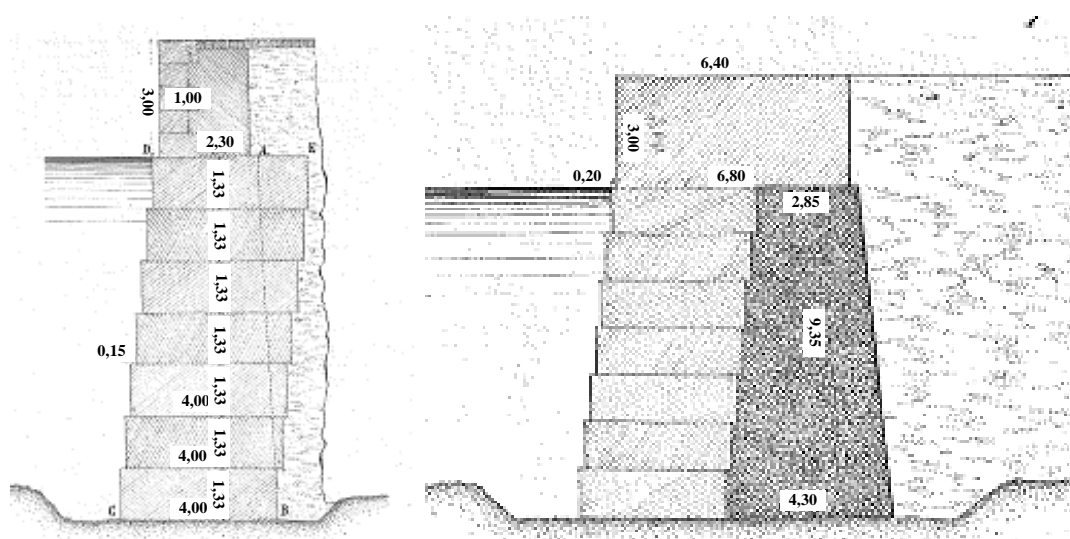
Diferentes secciones del muro construido con bloques de hormigón (Bellido, 1882).
